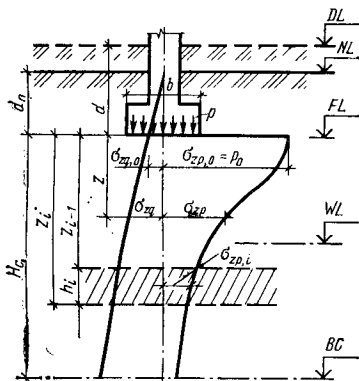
Схема распределения вертикальных напряжений при определении осадок методом послойного суммирования
